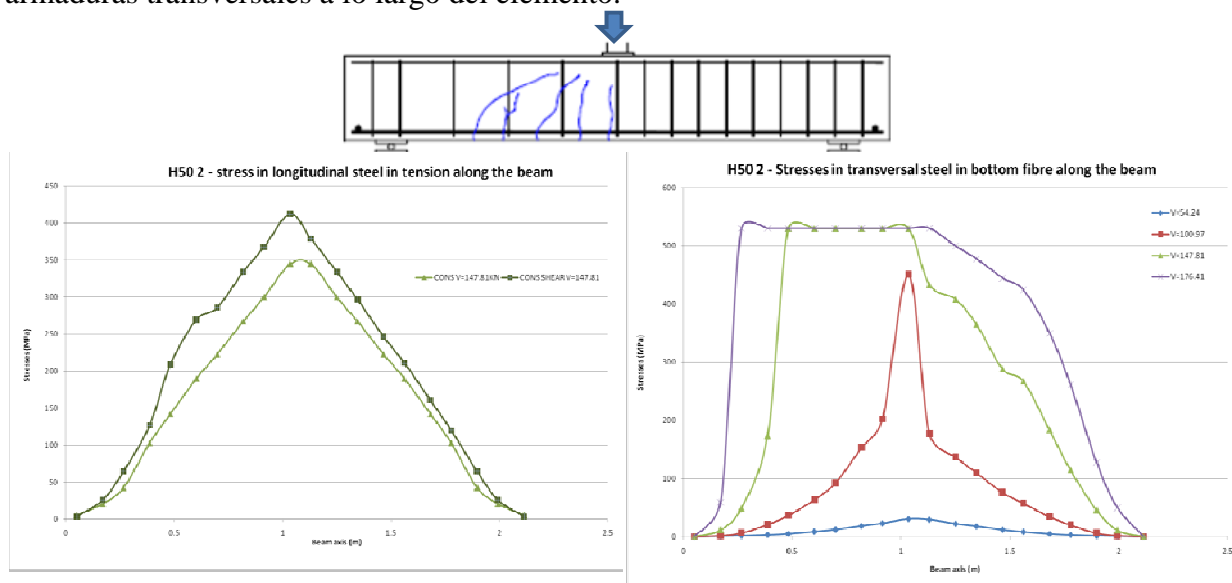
Predicción tensiones armaduras longitudinales y transversales
